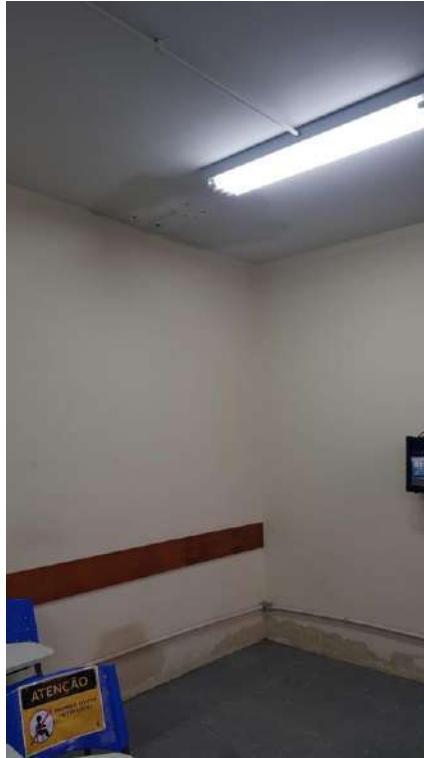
a 24 - Infiltração na laje da Sala 08.
